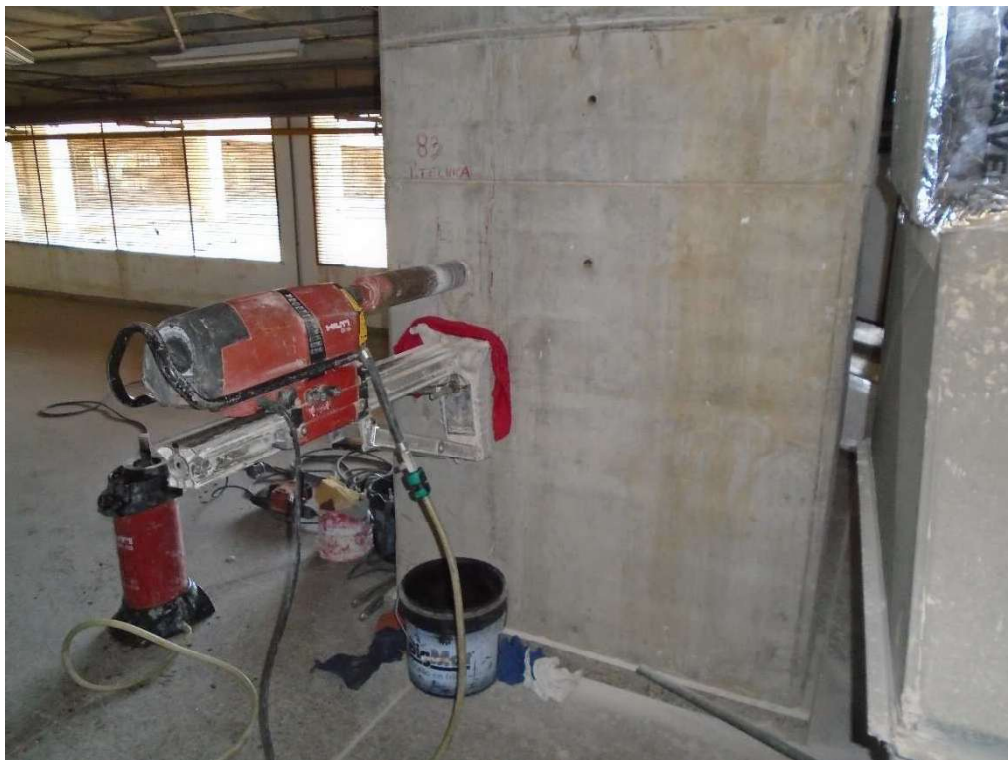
Vista extracción de testigo en pilar 83 en planta técnica (entresuelo)
